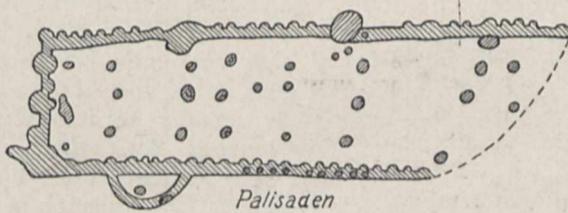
Grundriß eines über 20 m langen rechteckigen Baues, dessen Zweck nicht erkennbar ist
